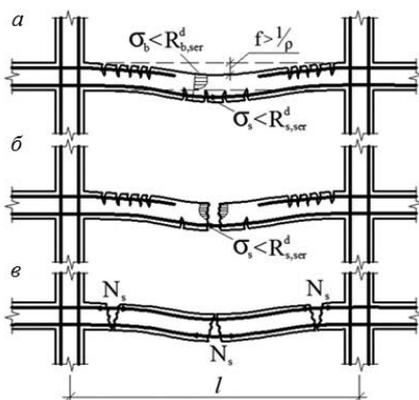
К критериальной проверке железобетонных элементов конструктивной системы при «пластическом» (а) «хрупком» (б) разрушении и для случая расчета как висячей нити (в)
